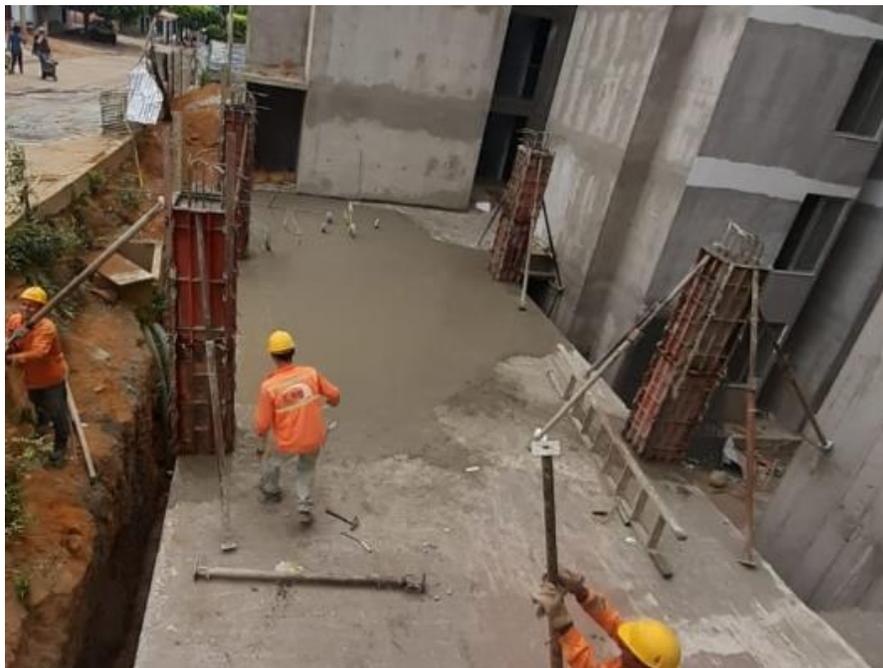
Verificación acero de refuerzo de placa de entrespiso Portería del proyecto Reserva del Rosario.
